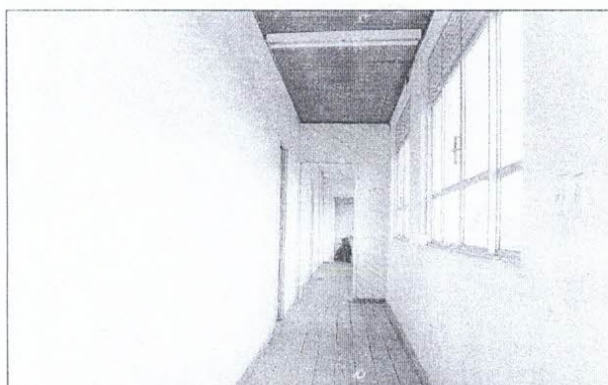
Área de circulação do pavimento superior. Piso em madeira precisando de revisão e troca, forro em madeira precisando de revisão e pintura e se possível troca das divisórias.
